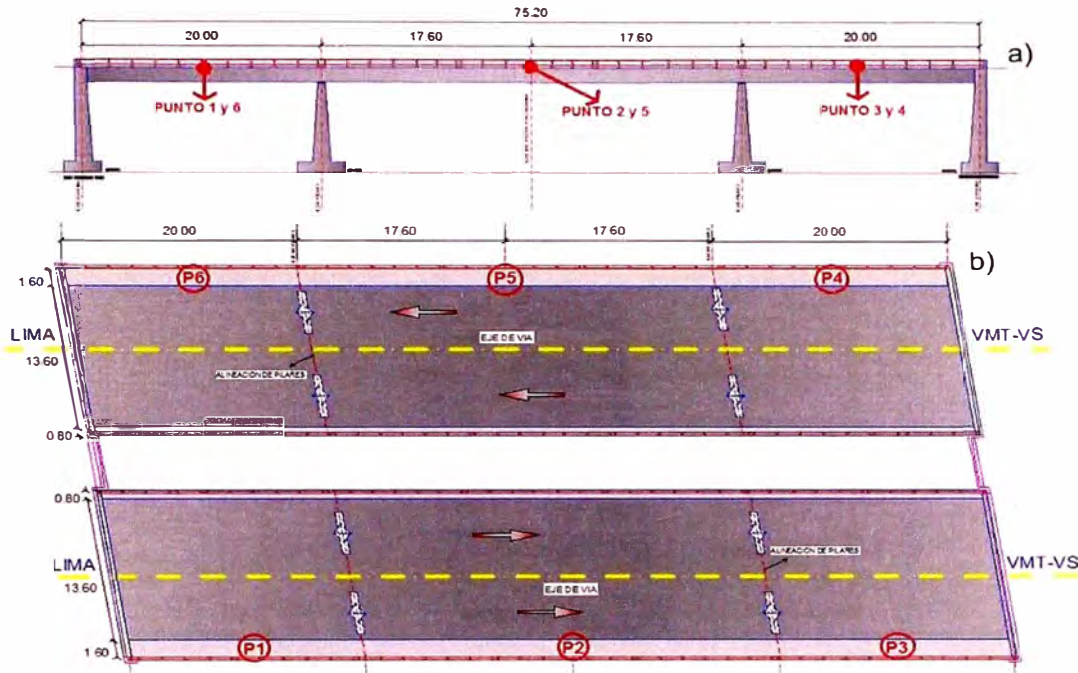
Ubicación de los ensayos de vibraciones a) Elevación y b) Vista en planta del puente Atocongo
